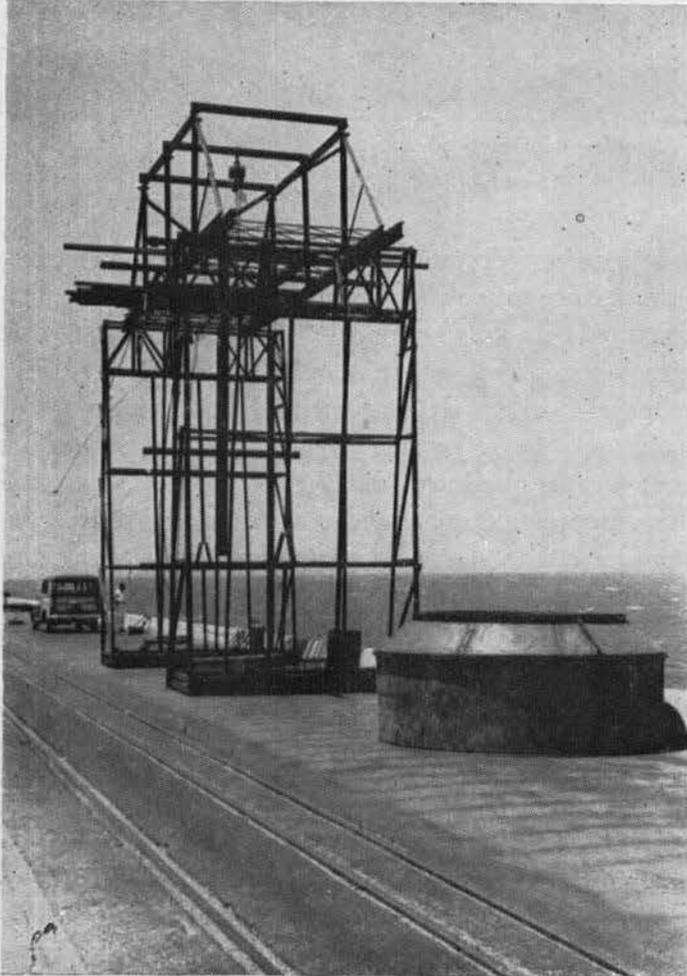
Obra falsa y sección del molde para la base de la pila.
